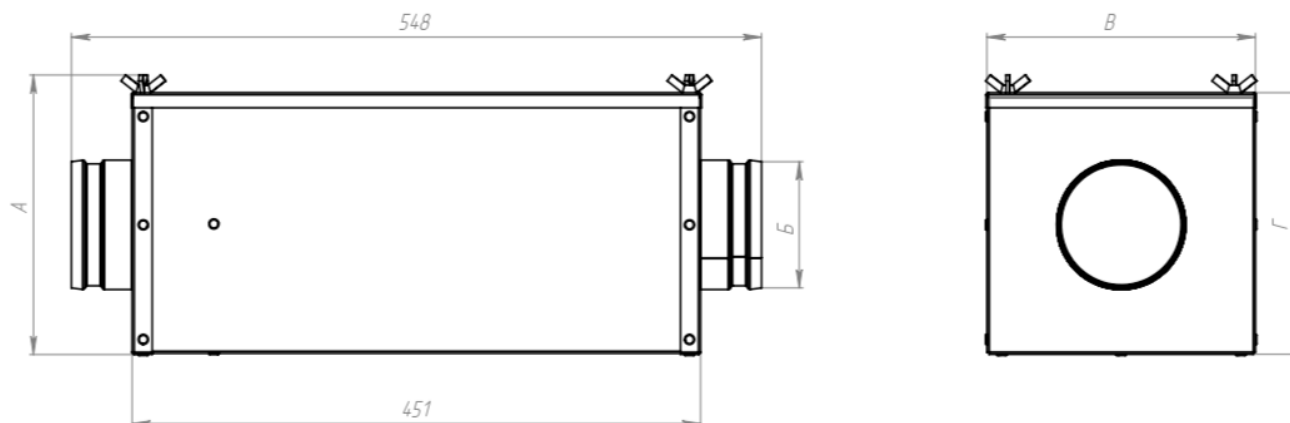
Внешний вид и основные размеры фильтров КKR
